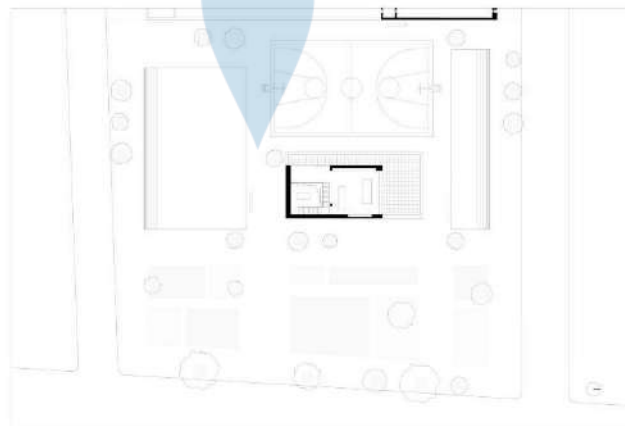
Denah Lantai 1 The Qingchang Village Town Hall Di China
